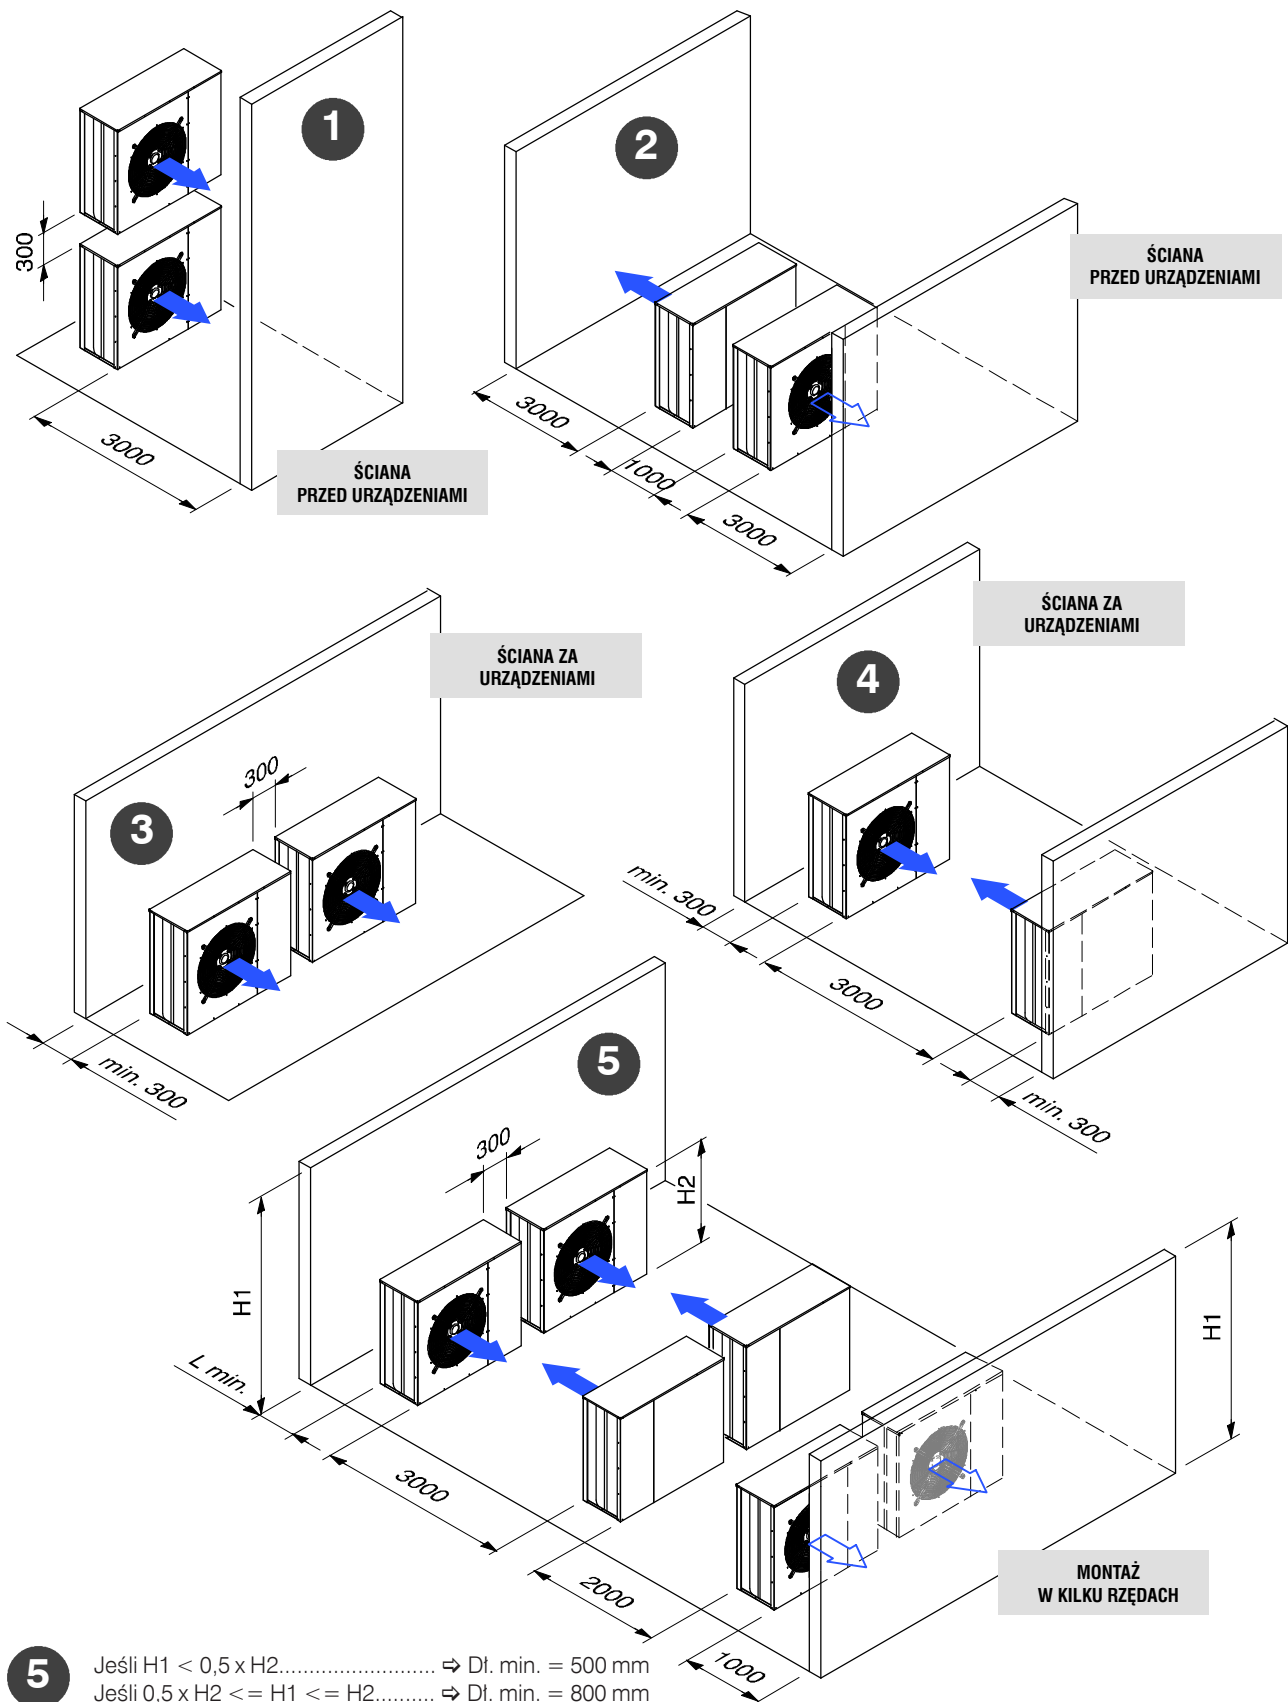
Elementy montażowe skraplacza HPSC 06-08-10-12-14
